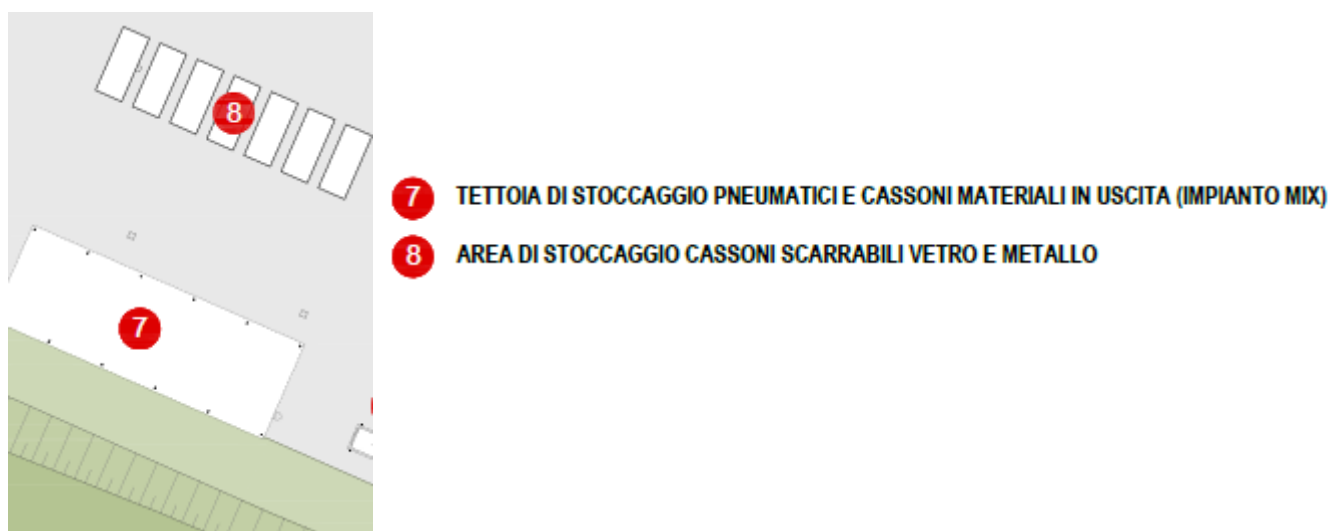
Estratto planimetria generale (Stato di progetto) – Area 3
